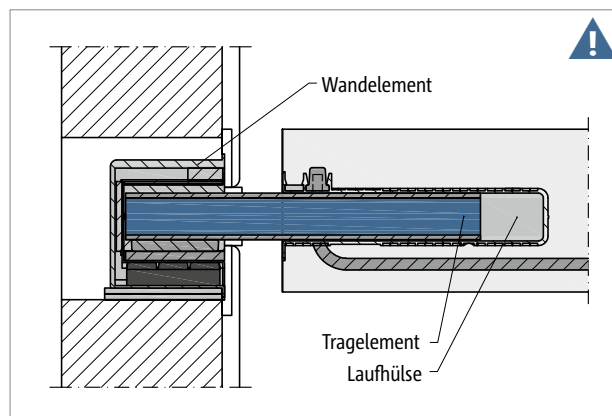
Tronsole® Q: Mehrteiliges Produkt (Wandelement, Tragelement, Laufhülse); Tragelement (eingefärbt) muss auf der Baustelle eingebaut werden.
